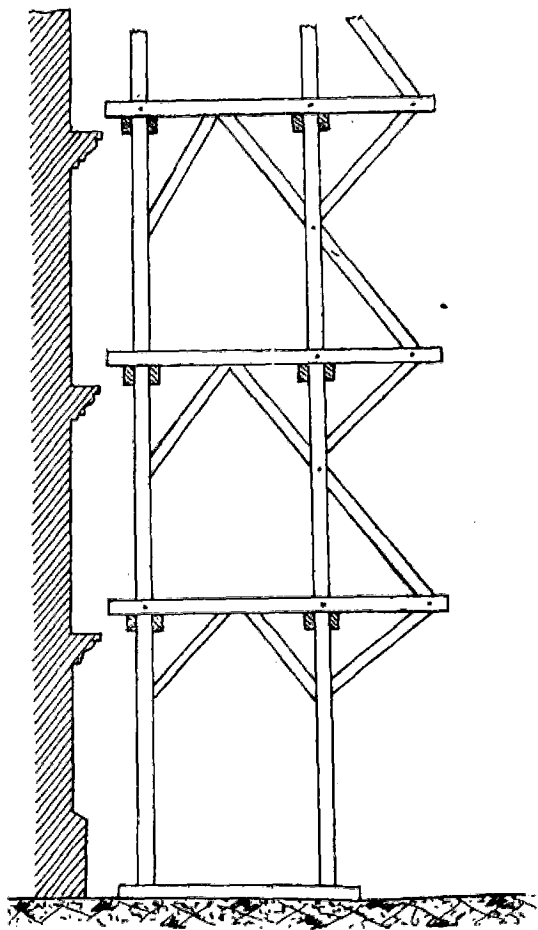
Autre exemple d'échafaudage avec contreventement transversal différent.
